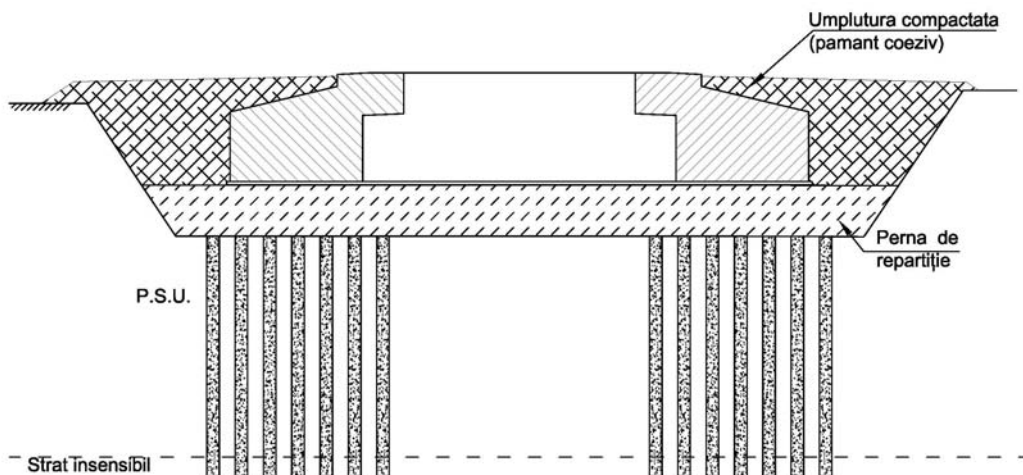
Fundarea pe teren îmbunătățit cu coloane de îndesare din beton
